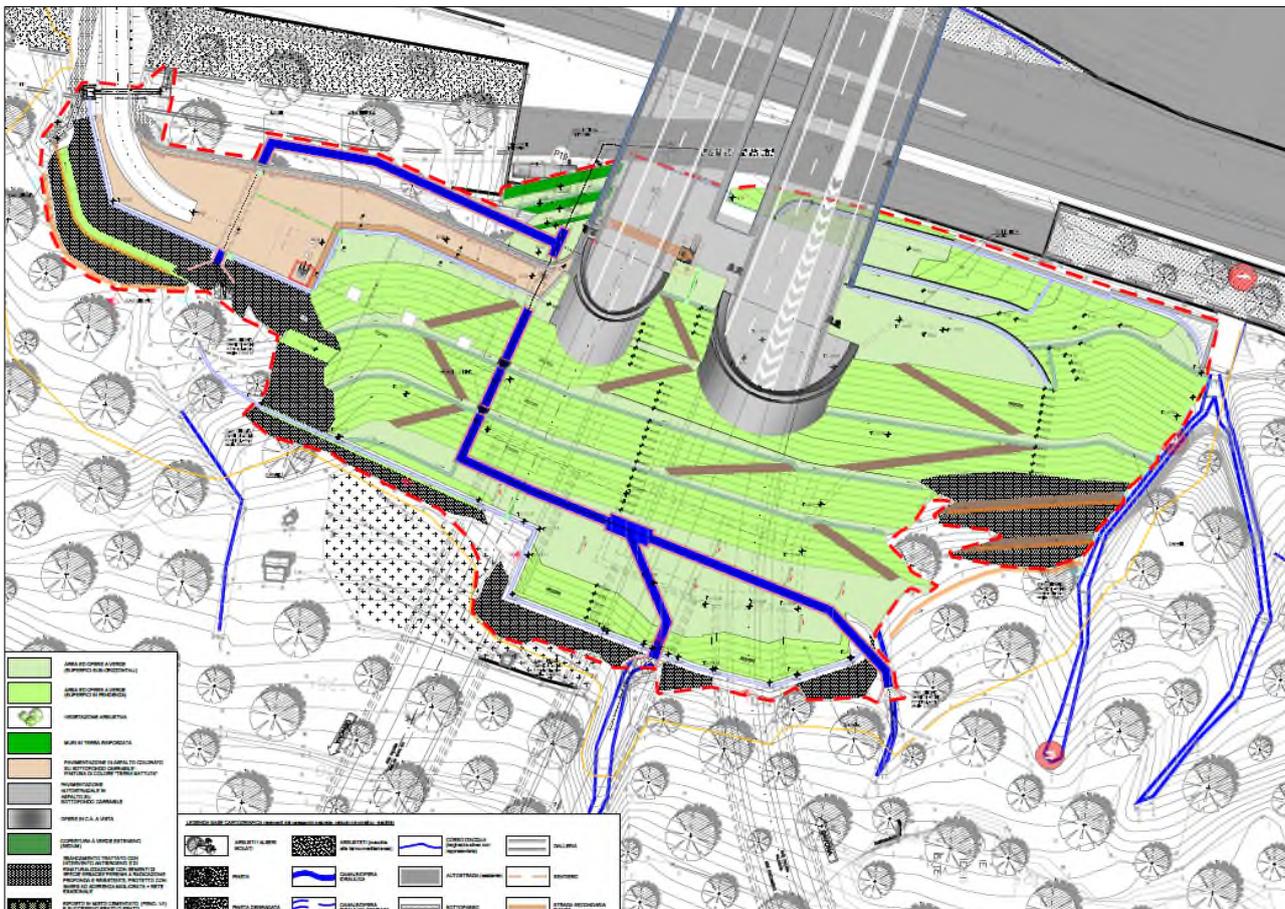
Planimetria dell'area d'imbocco (fonte: elaborato 110722-LL02-PE-A3-G12-GF12W-SSF00-D-AUA1573-1)
